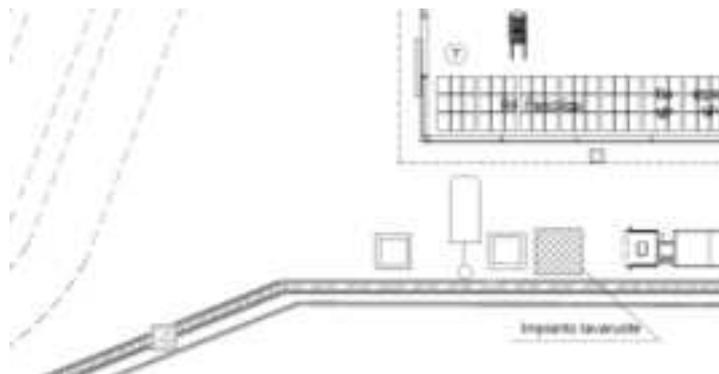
Strabico planimetrico relativo all'area di lavaggio delle ruote
